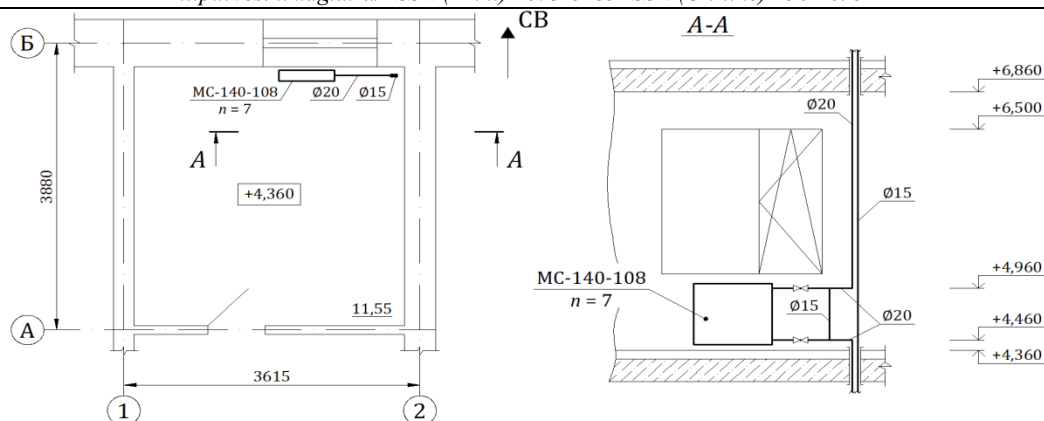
План и местный поперечный разрез комнаты в жилом здании
